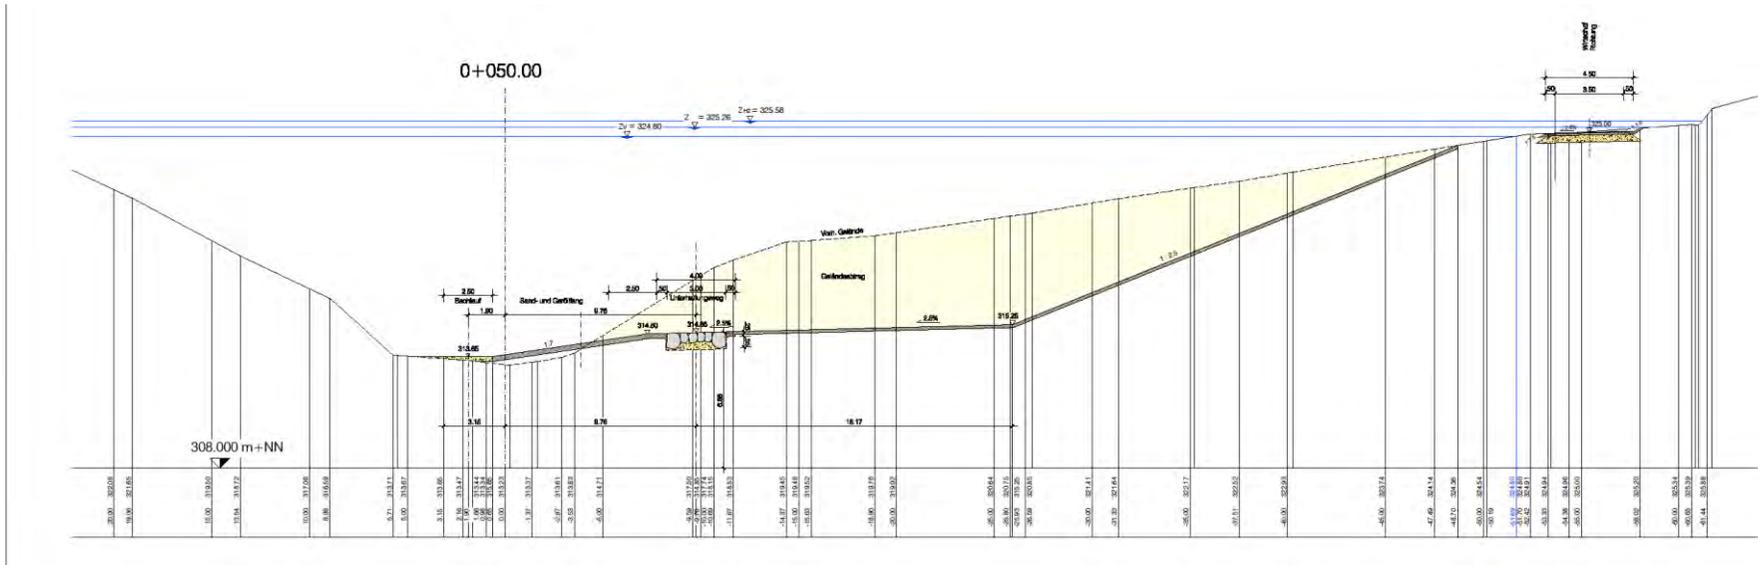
Querschnitt beim km 0+050 mit Darstellung des geplanten Stauraumabtrages (Quelle: Zink Ingenieure, 2016, unmaßstäblich).
